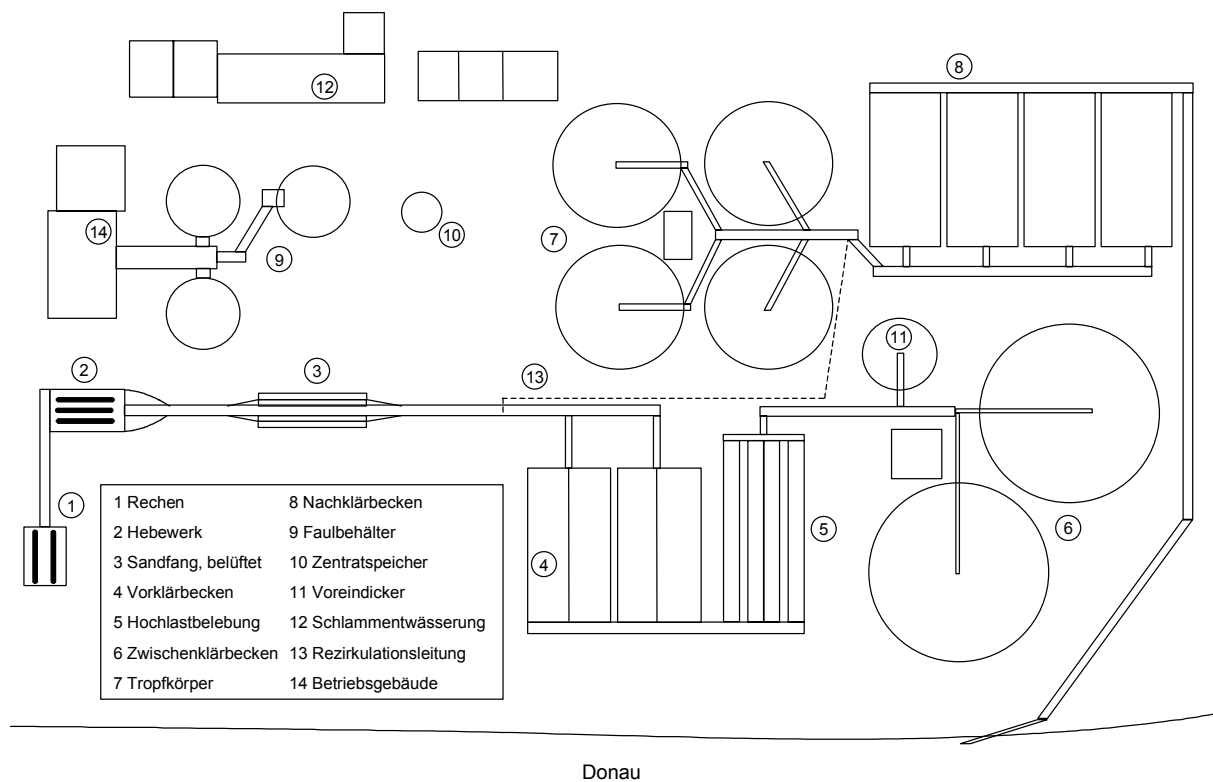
Lageplan der Zentralkläranlage Ingolstadt (Stand: 1998)
